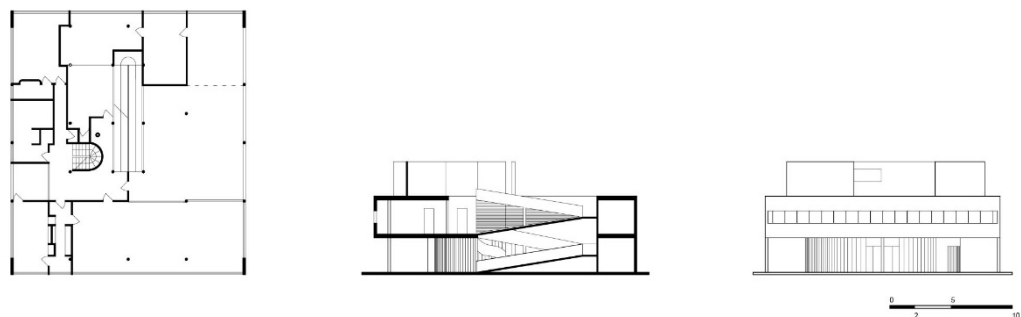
Redesenho da planta, corte e elevação - Villa Savoye
